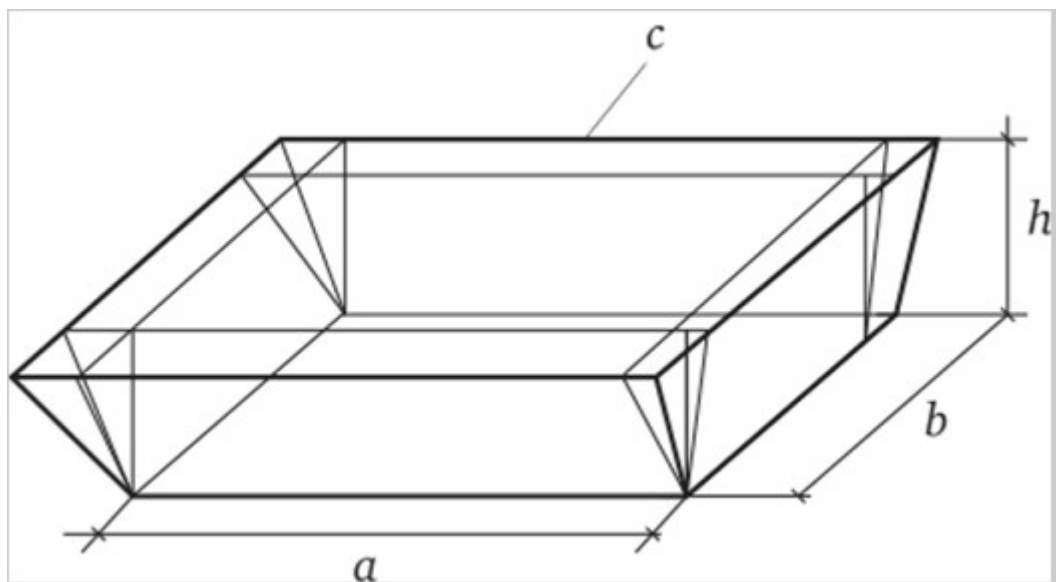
Схема разработки котлована или траншеи со всеми наклонными стенками
